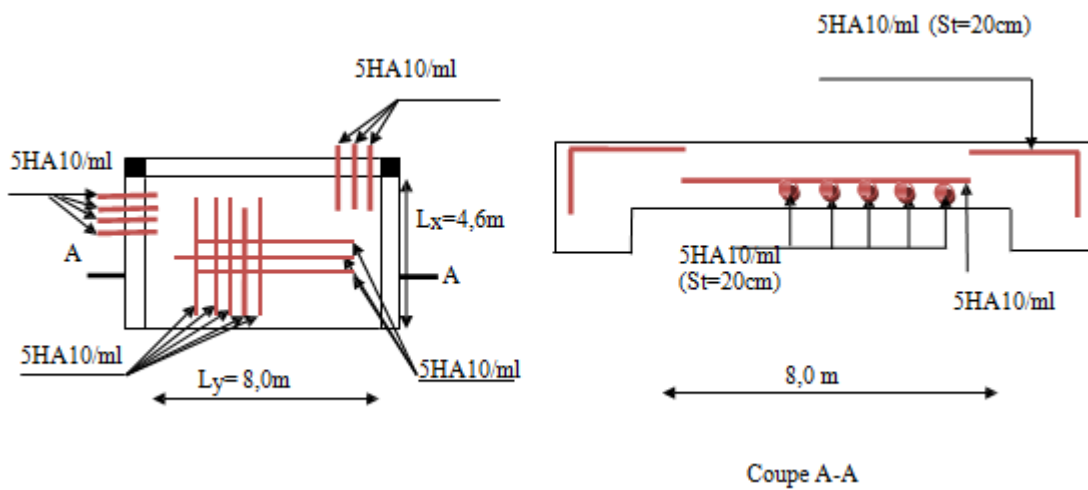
Disposition constructive des armatures des dalles pleine du type 2 (les sous-sols).
